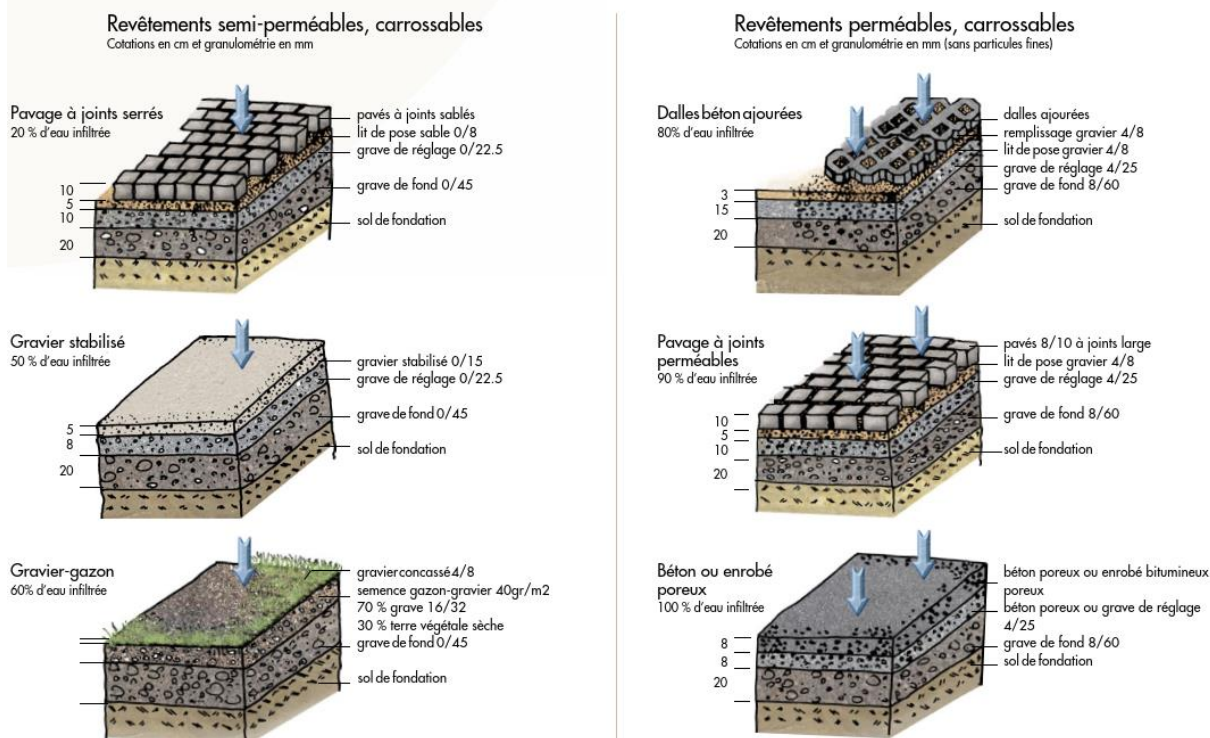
Schema illustrativo della capacità di infiltrazione delle acque, estratto dalla "Guide des aménagements extérieurs sur fonds privés de la ville de Sion" elaborato dalla Città di Sion nell'ambito di una politica integrata di lotta alle isole di calore
